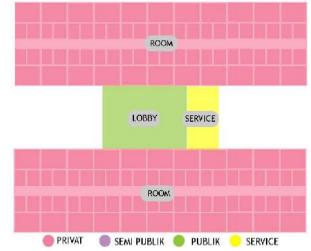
Blok Plan Vertikal per lantai - Third Floor (3) (Sumber: Analisis, 2020)
